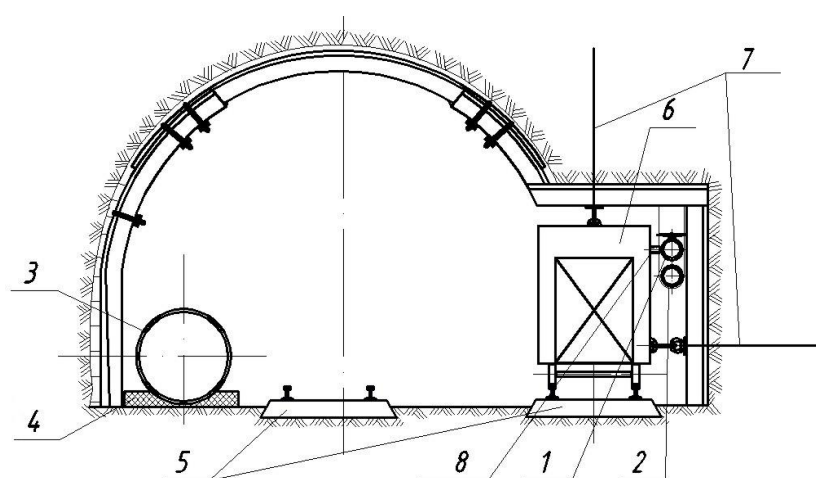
Размещение мобильной установки «Релаксатор» в нише горной выработки: 1- трубопровод сжатого воздуха; 2 – противопожарный трубопровод; 3 - дегазационный трубопровод; 4 – подложка (не металлическая); 5 - рельсовая дорога типа ДКНЛ-1; 6 – мобильная установка или передвижная камера-убежище; 7 - анкера крепления камеры-убежища; 8 - подвод сжатого воздуха к камере.
